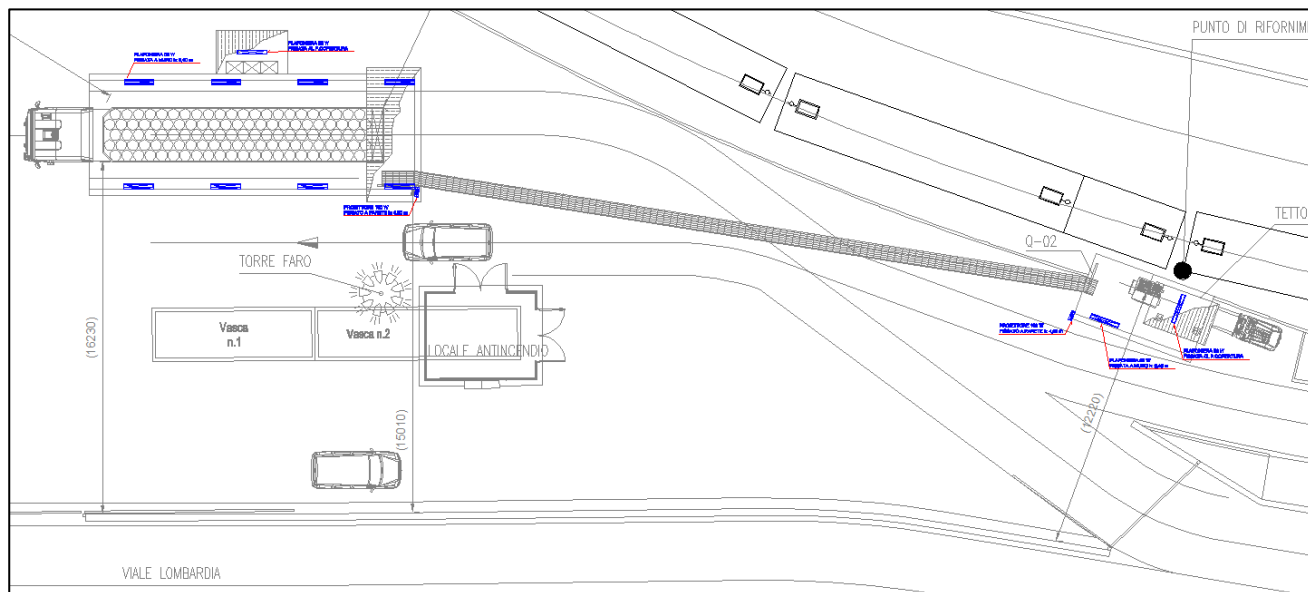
Disposizione apparecchi illuminanti in planimetria
